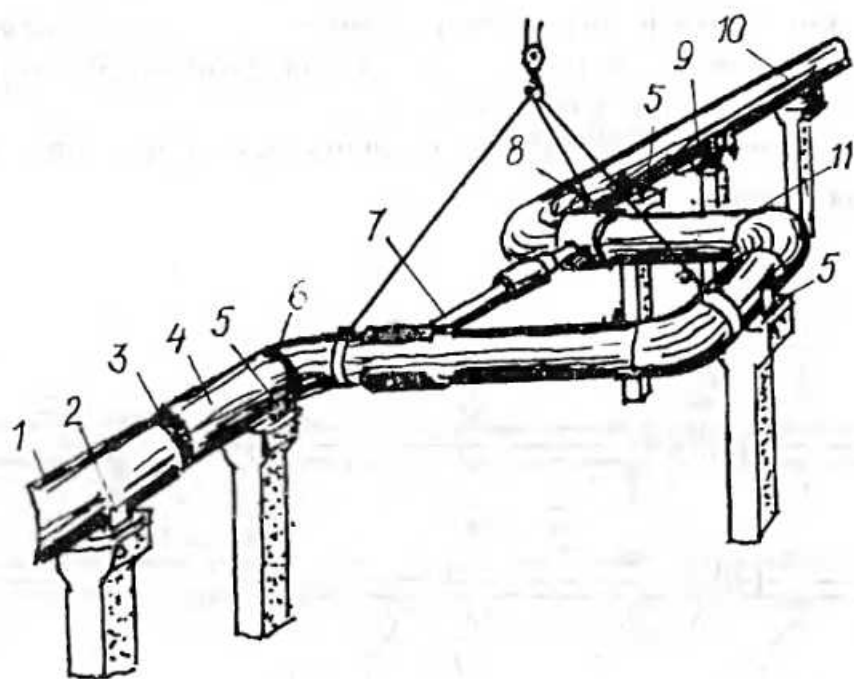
Схема монтажу П-подібного компенсатора з попереднім розтягуванням: 1, 4, 9 - деталі трубопроводу; 2, 5, 10 - опори; 3, 6, 8 - зварні стики трубопроводу; 7 - розпирний пристрій; 11 - компенсатор
